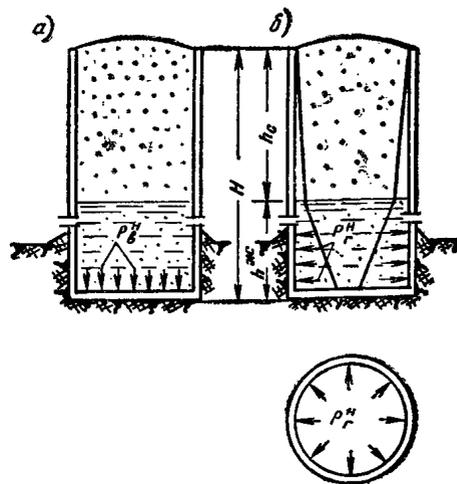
Схемы нагрузок от давления силосной массы на стены и днища башен
